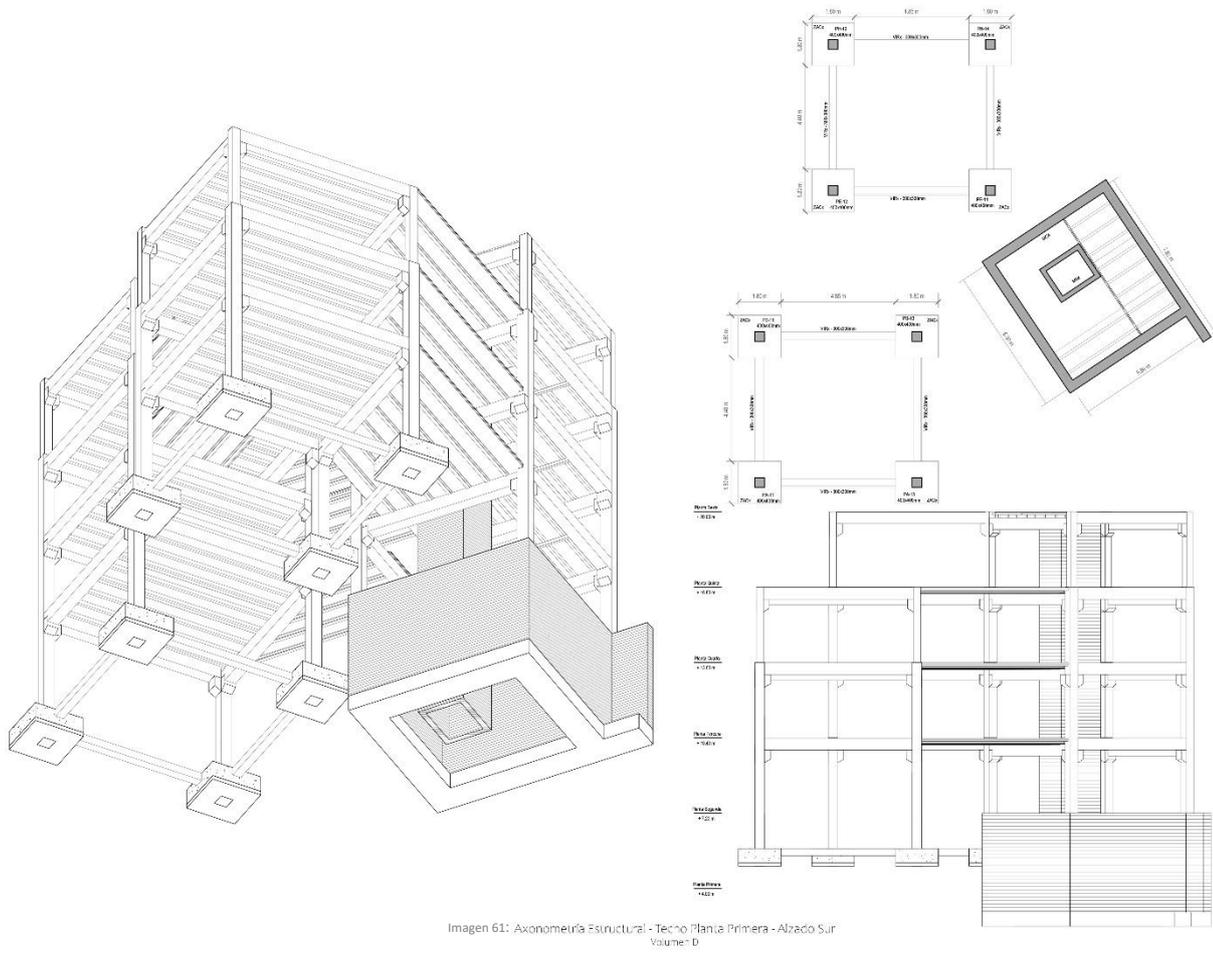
Axonometría Estructural - Techo Plana Primera - Alzado Sur
